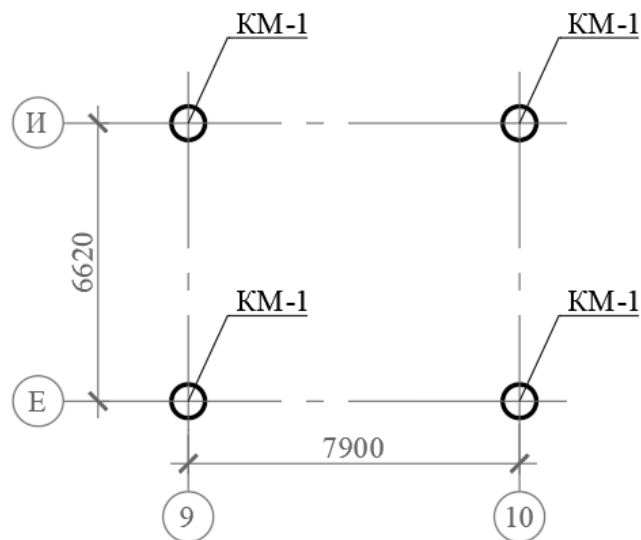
Схема расположения железобетонных колонн в осях Е-9, И-10
